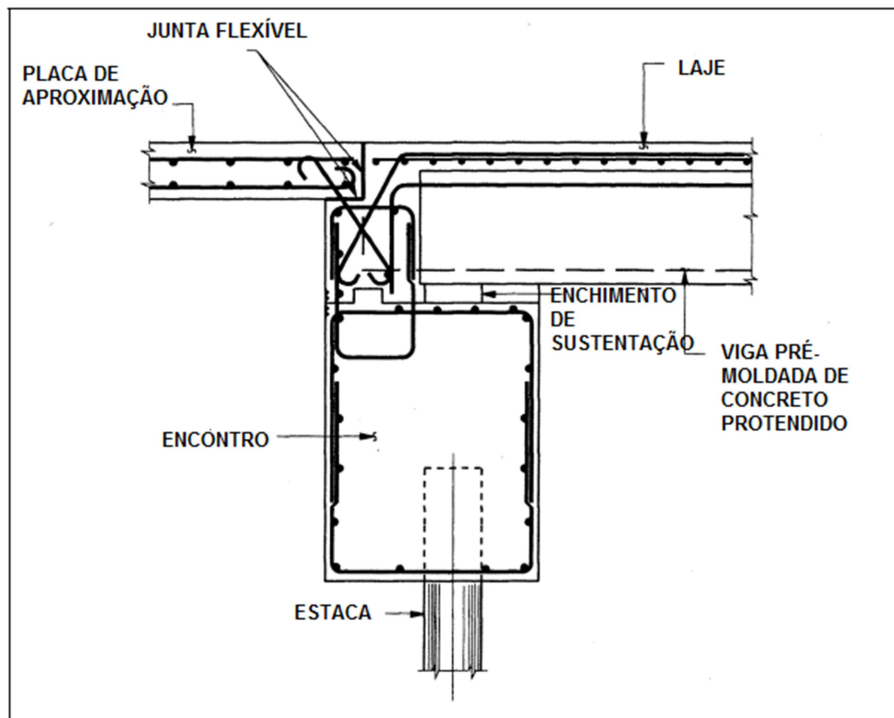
25: Atual padrão de encontro integral para superestruturas com vigas pré-moldadas em concreto protendido adotado pelo *New York State Department of Transportation*. Fonte: YANNOTTI *et al.* (2005), adaptado.
